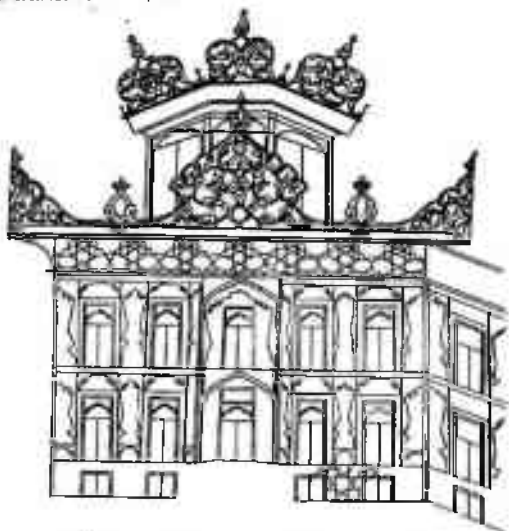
Фасад жилого дома, Зетчэй Муминджан, 1963 г.
